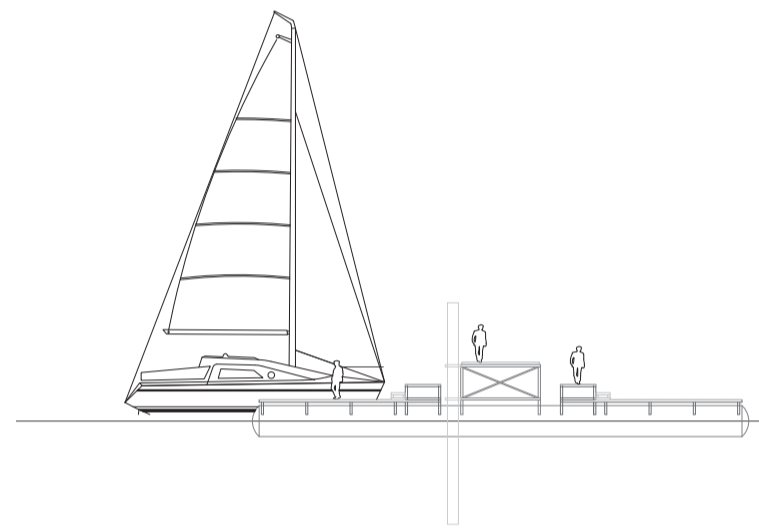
Dibujos del Autor - Detalles planimetricos muelles "fingers"
